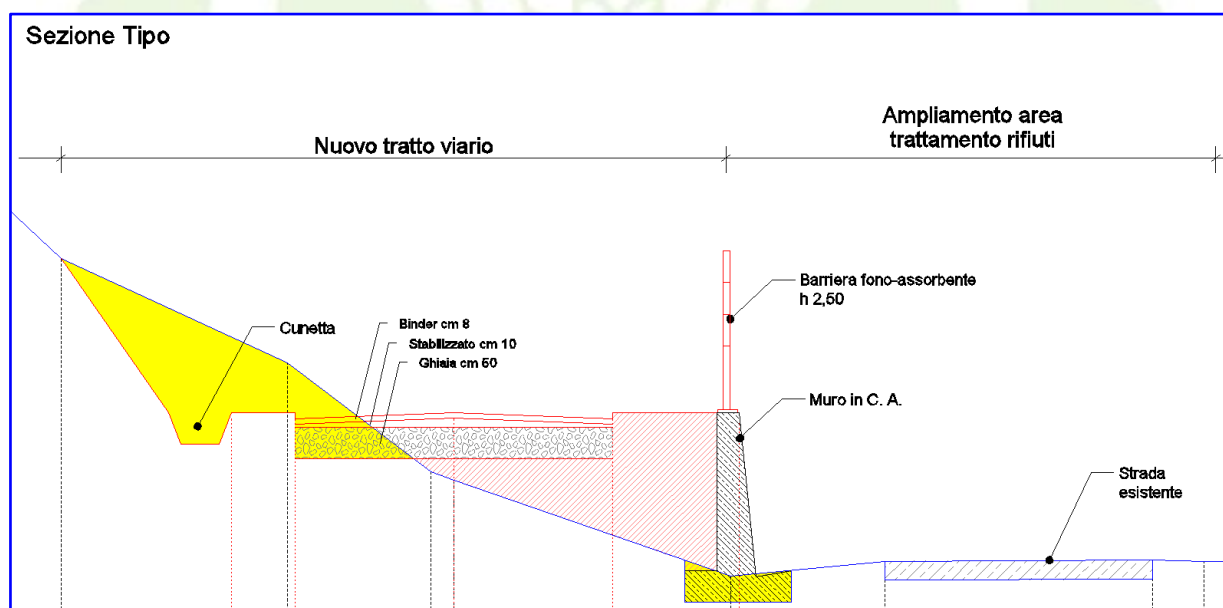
Sezione tipo della nuova viabilità con innalzamento relativo dell'infrastruttura e posizionamento di barriera
